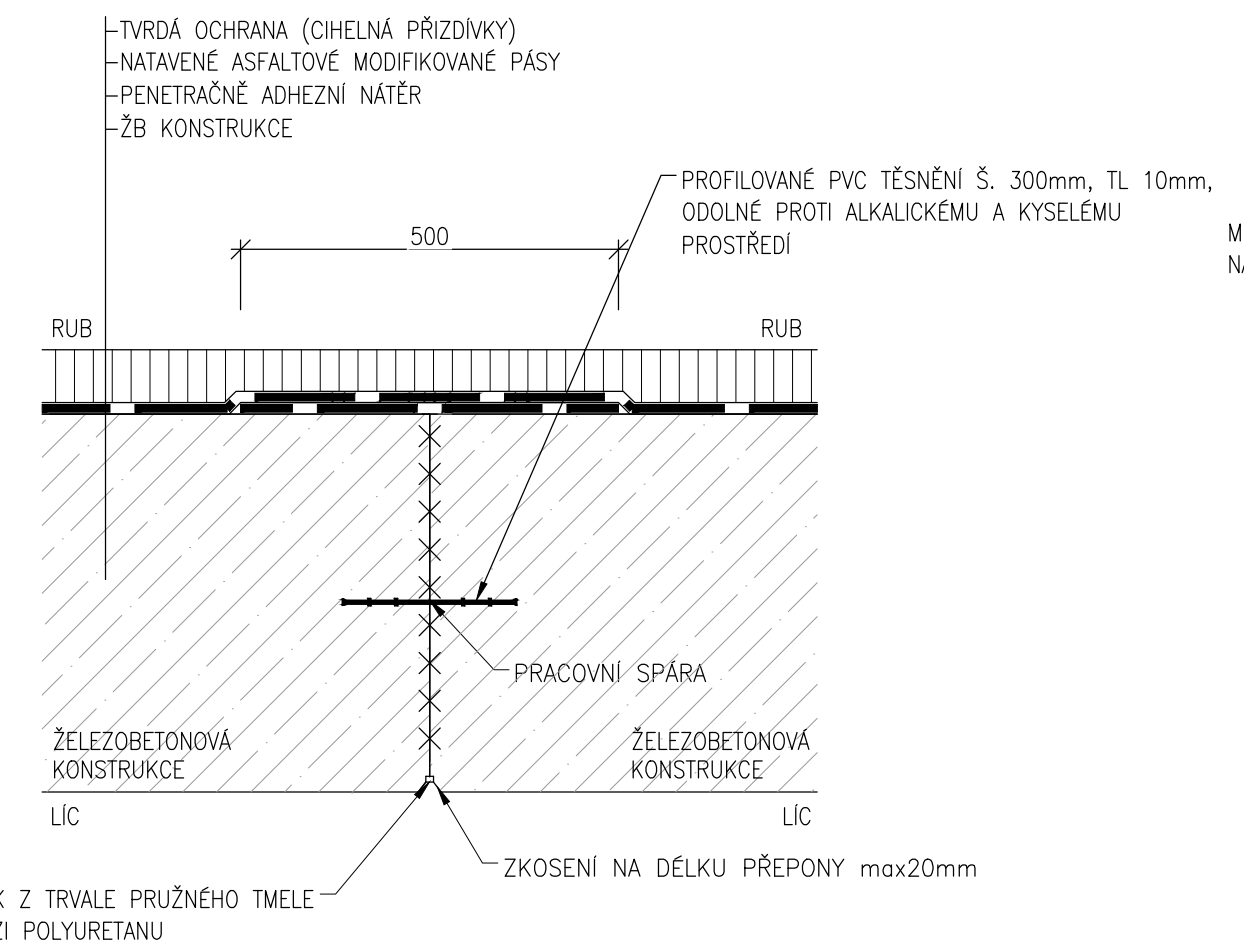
DETAIL ÚPRAVY PRACOVNÍ SPÁRY V HORNÍ DESCE
